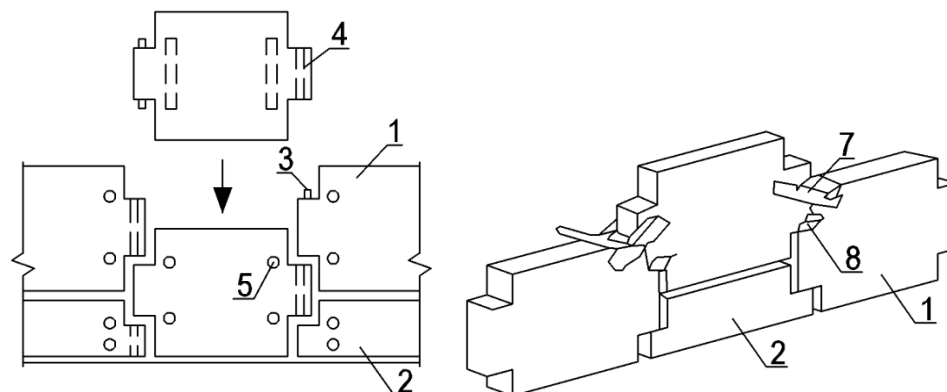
Конструкция железобетонной облицовки из отдельных плоских плит:
